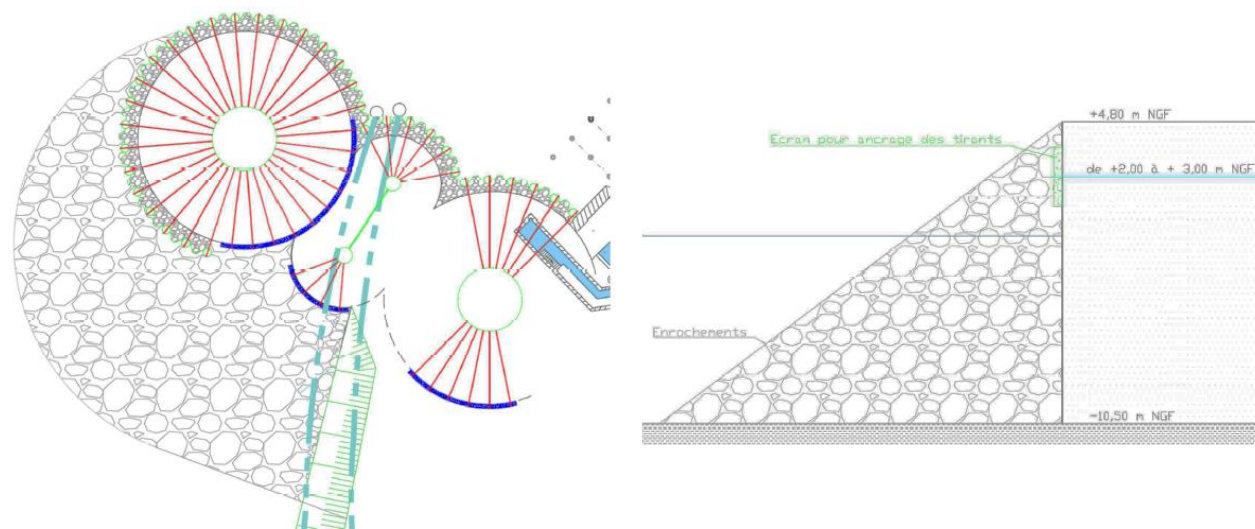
Solution de confortement mixte type combiwall (pieux + palplanches) + Enrochements - Vue en plan et coupe – Détail gabions aval
